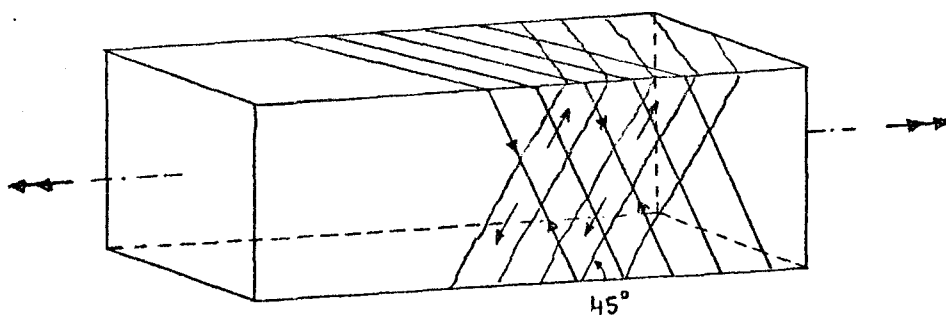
Räumliches Fachwerk mit Spiralbewehrung
